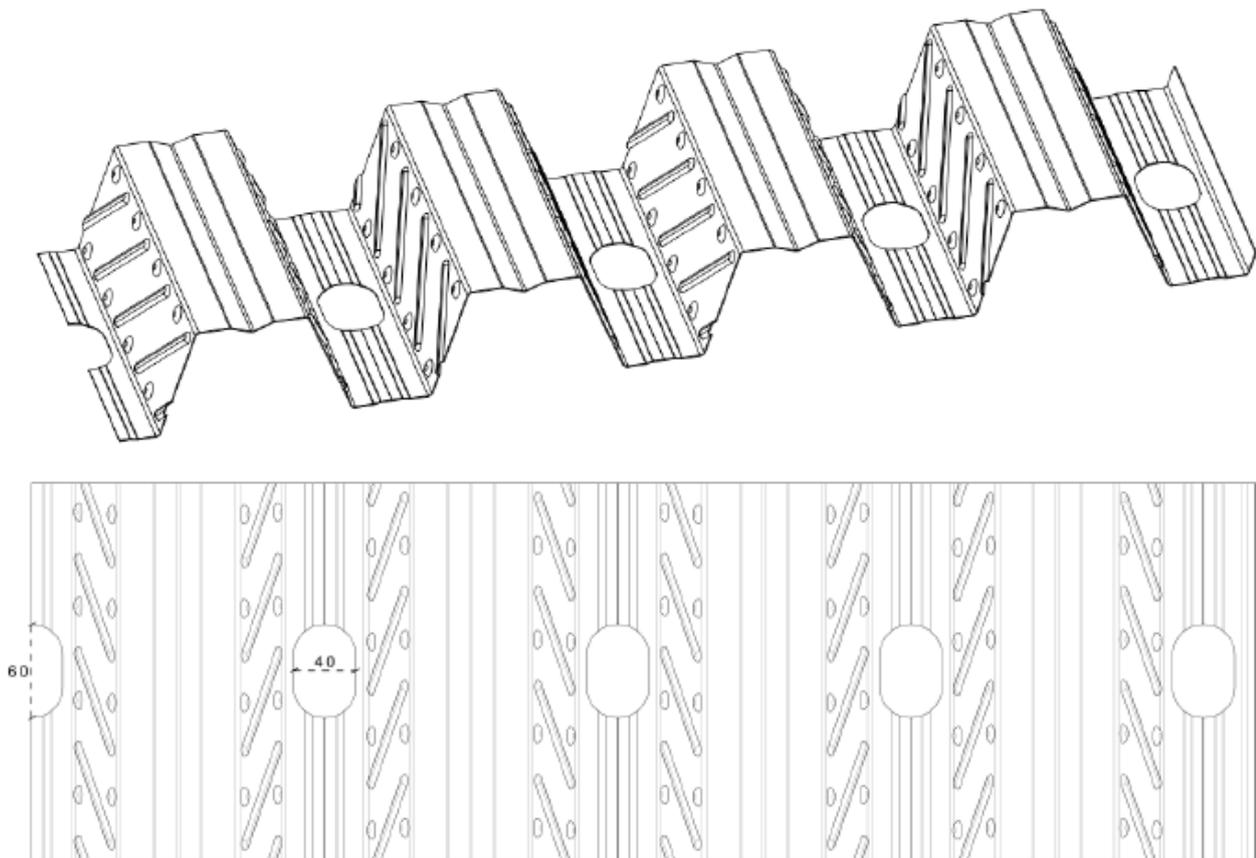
Dimension et localisation du trou de préperçage (PCB 80 PP)
